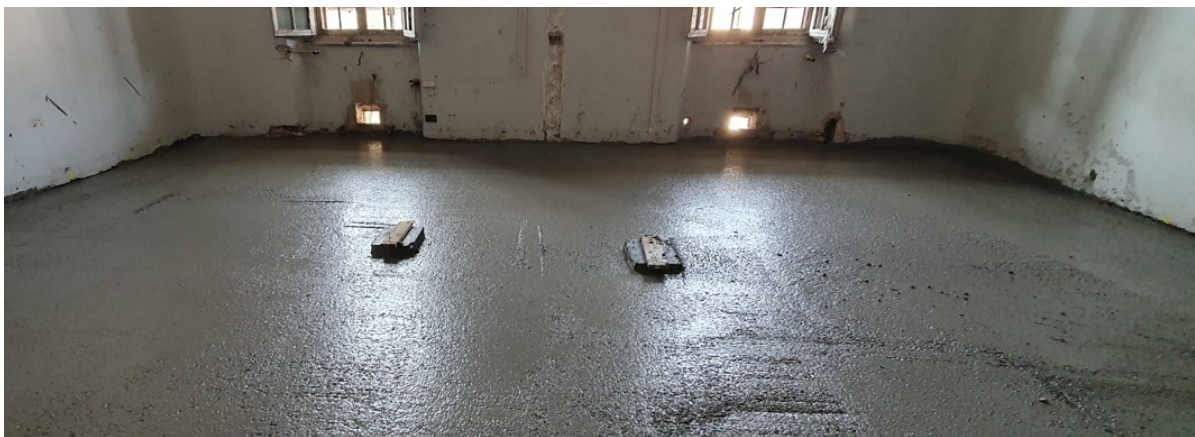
posa della rete elettrosaldata su distanziatori e getto finale (lavori di Studio Calvi BEAM BEAM)
